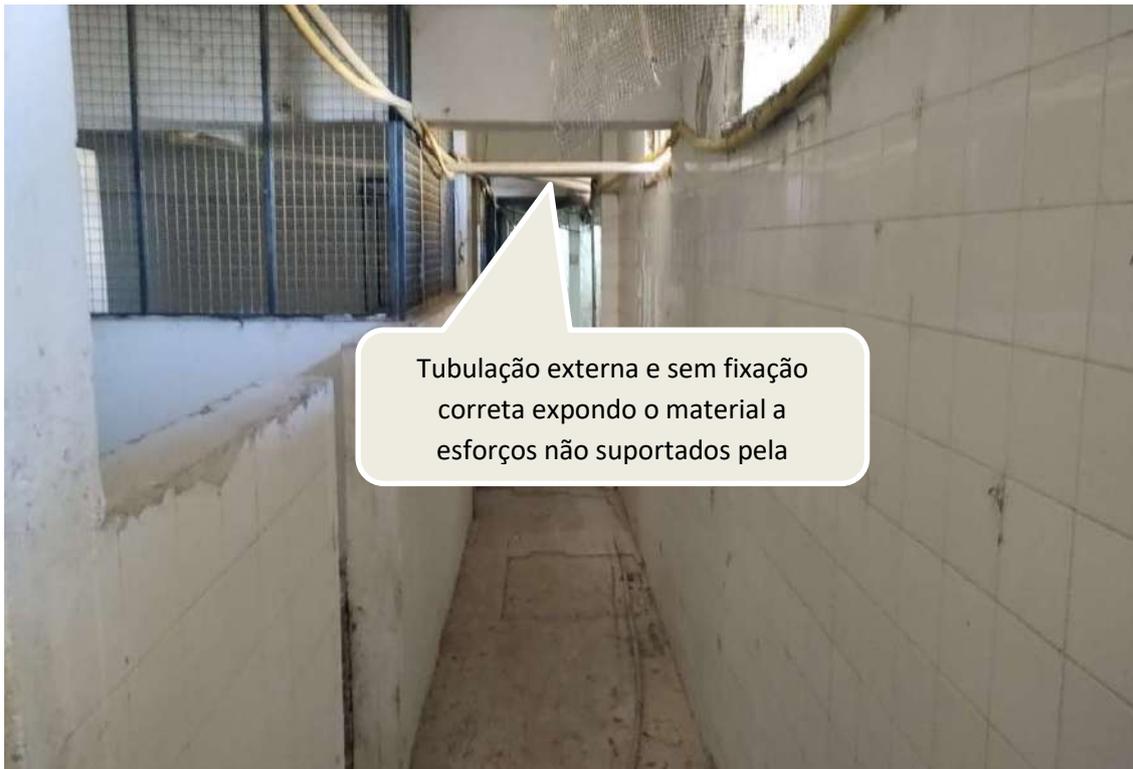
Tubulações em PVC afixadas em gradis, tetos e paredes, incorretamente instaladas e posicionadas.
